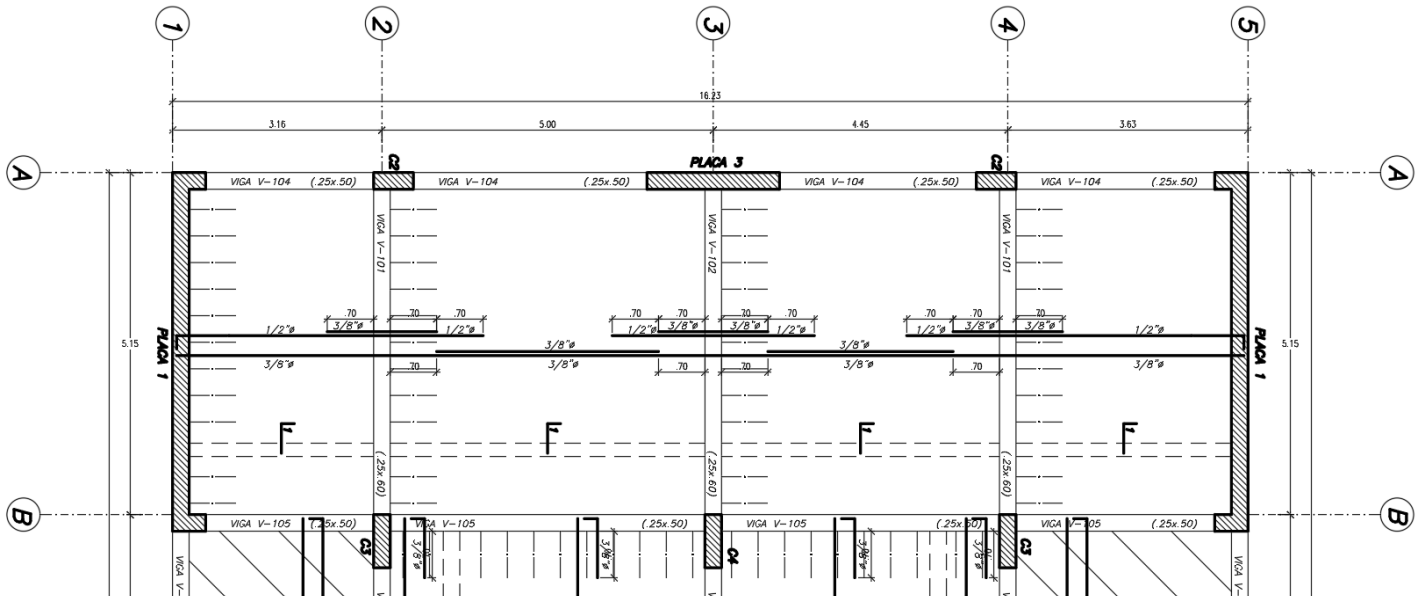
Armado de vigueta típica de losa aligerada de 20 cm de espesor.
